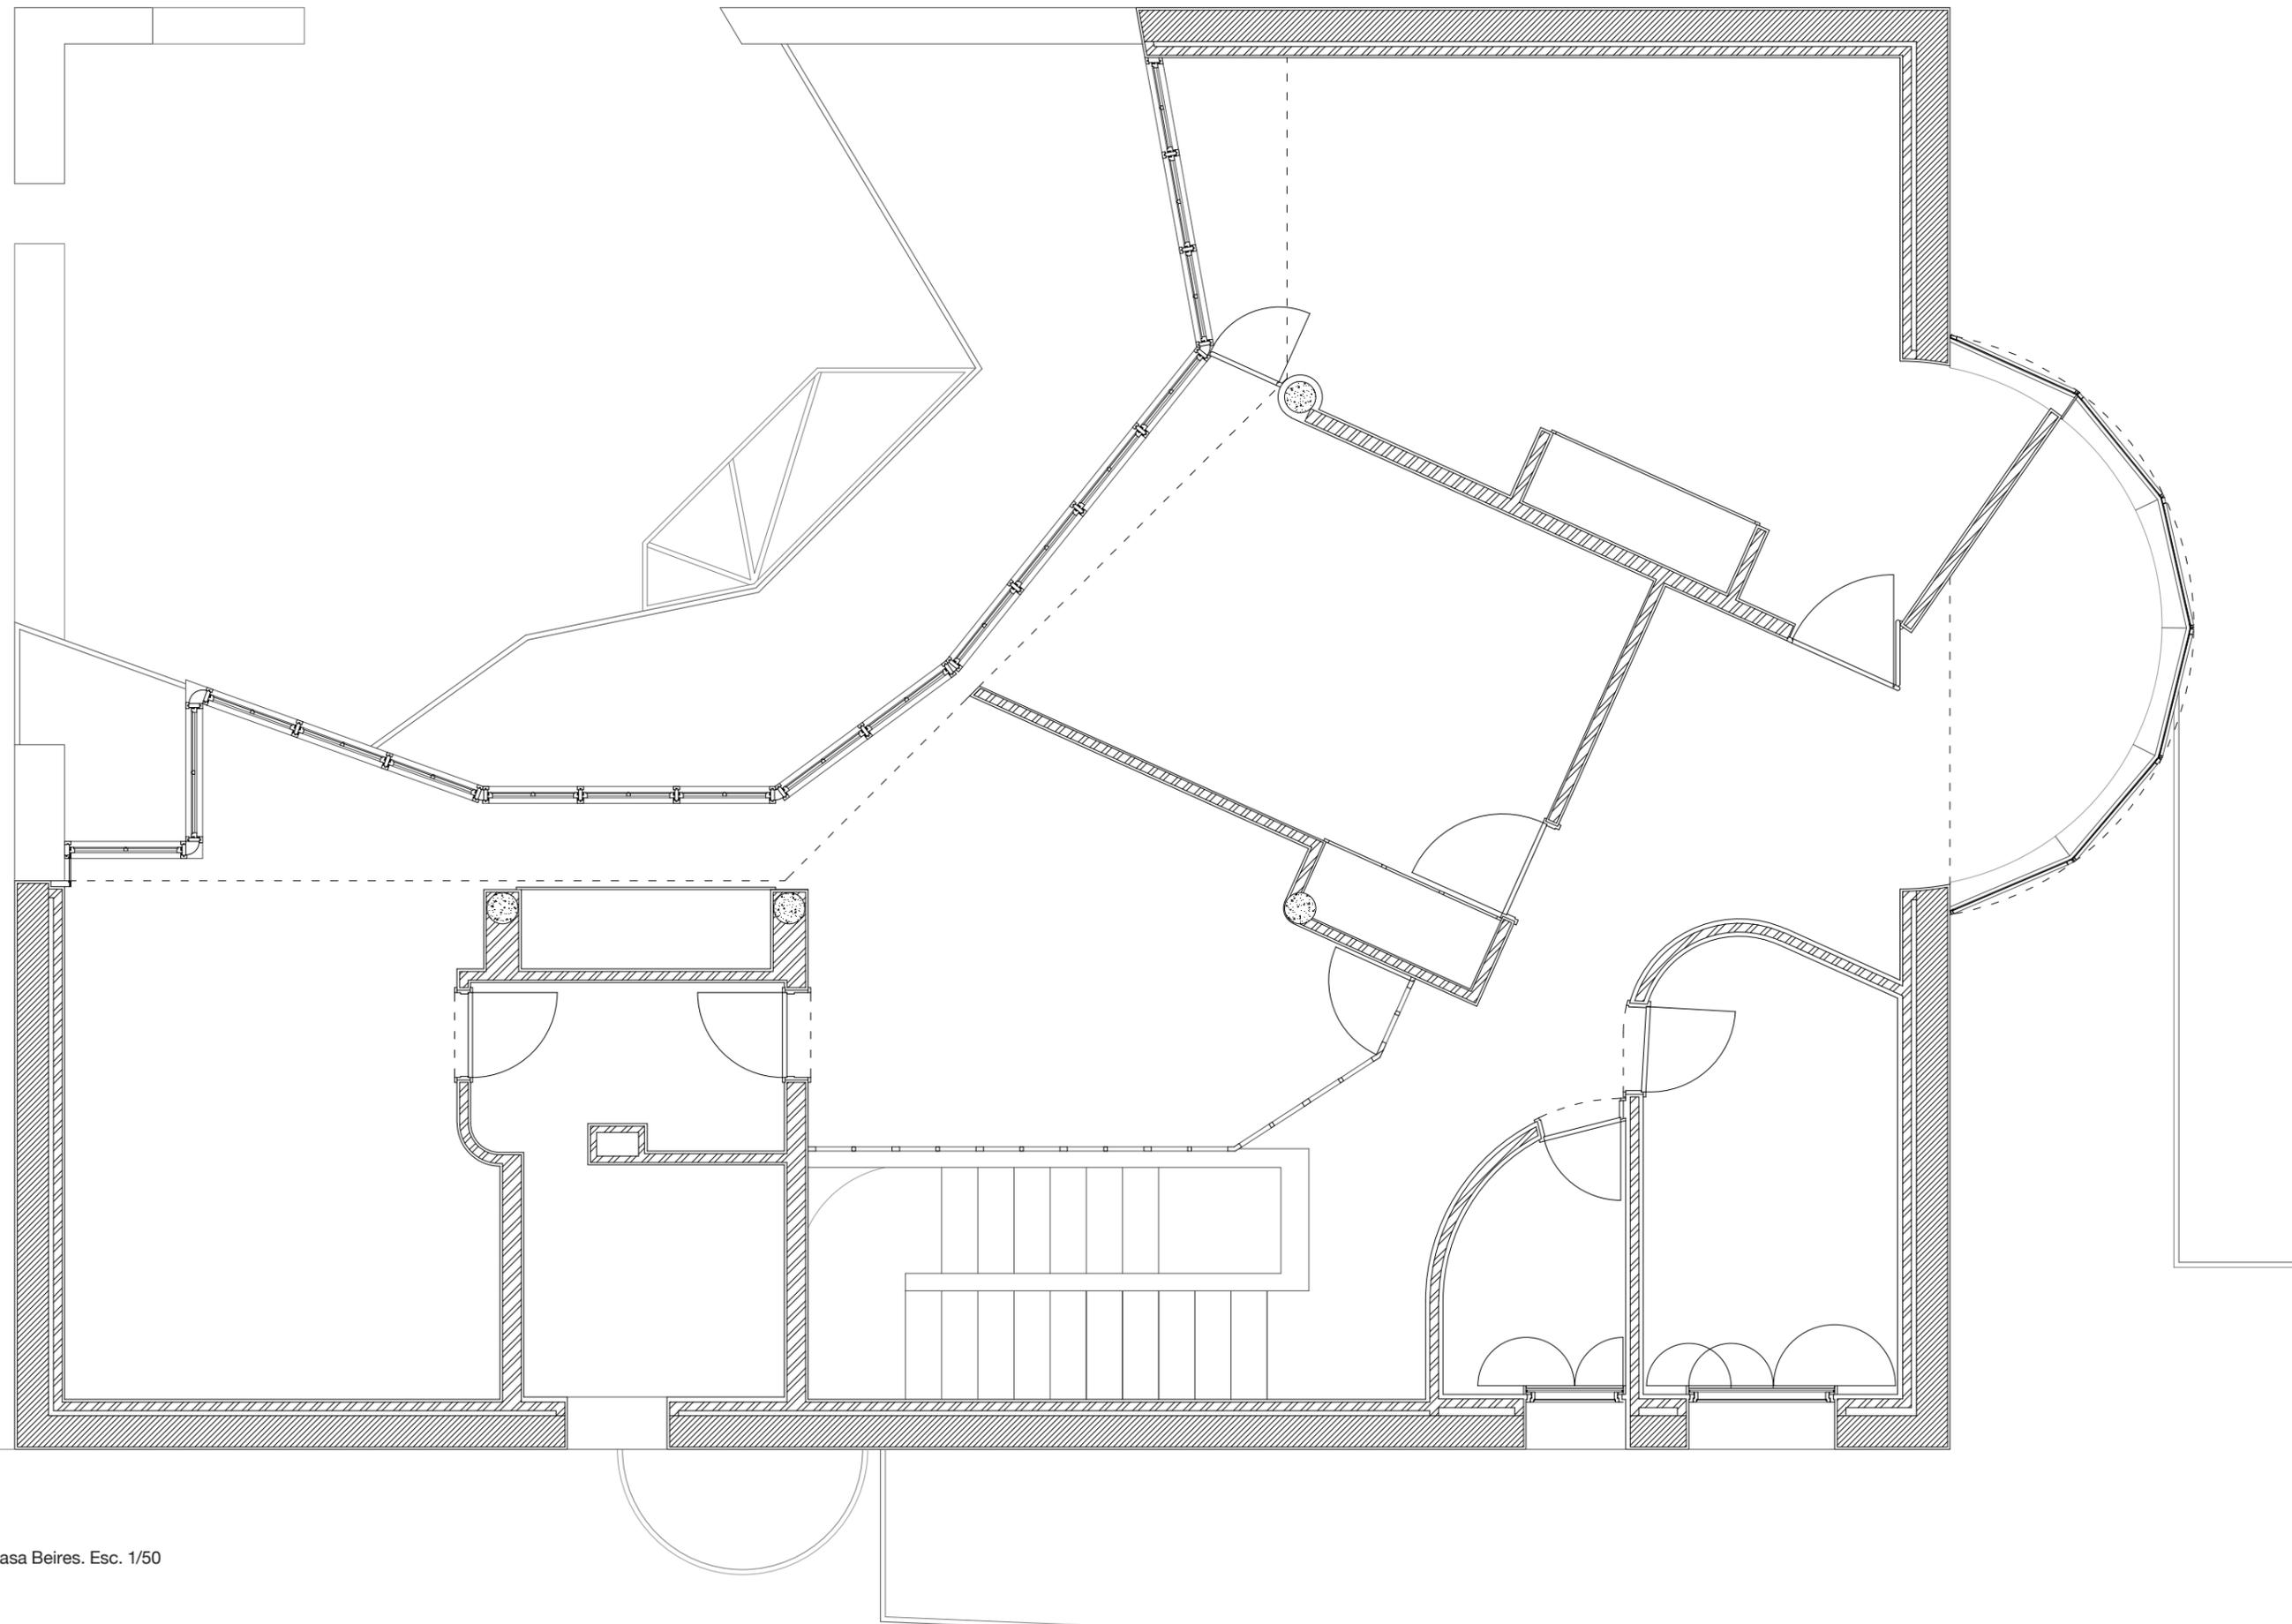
Planta do piso 1, Casa Beires. Esc. 1/50
